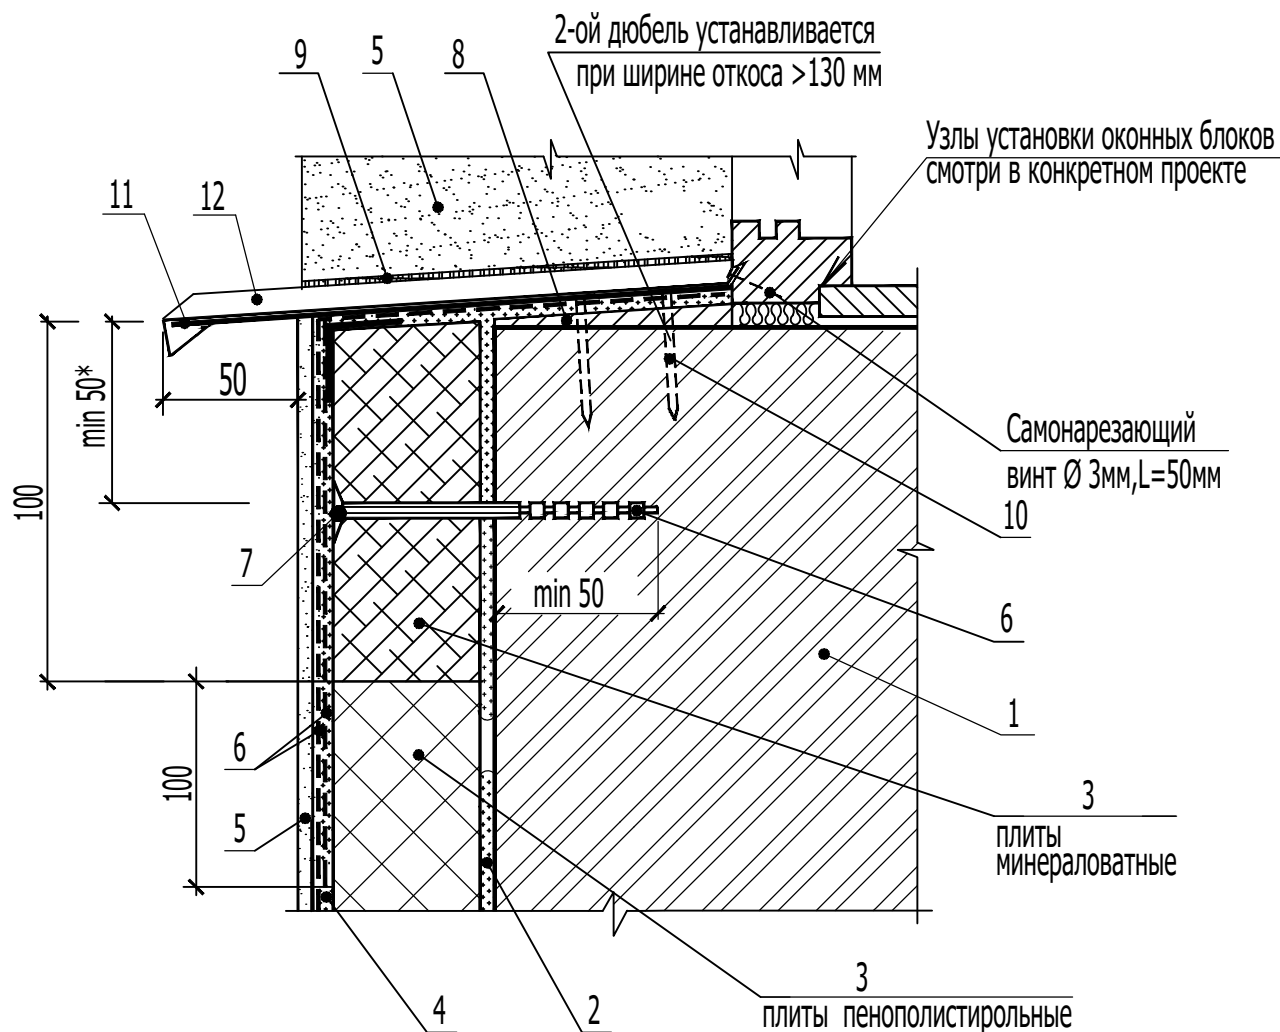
Узел отделки утепляемого бокового откоса окна панельного здания
